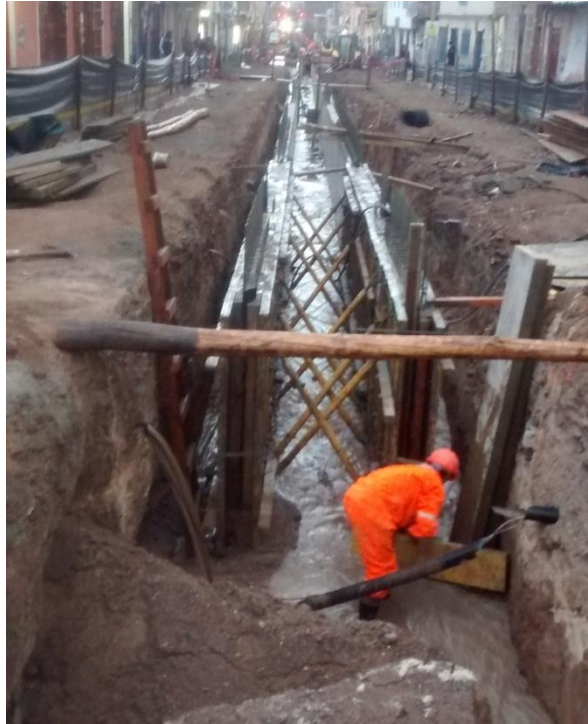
Encofrado de canal en el Jr. Manco Cápac.
